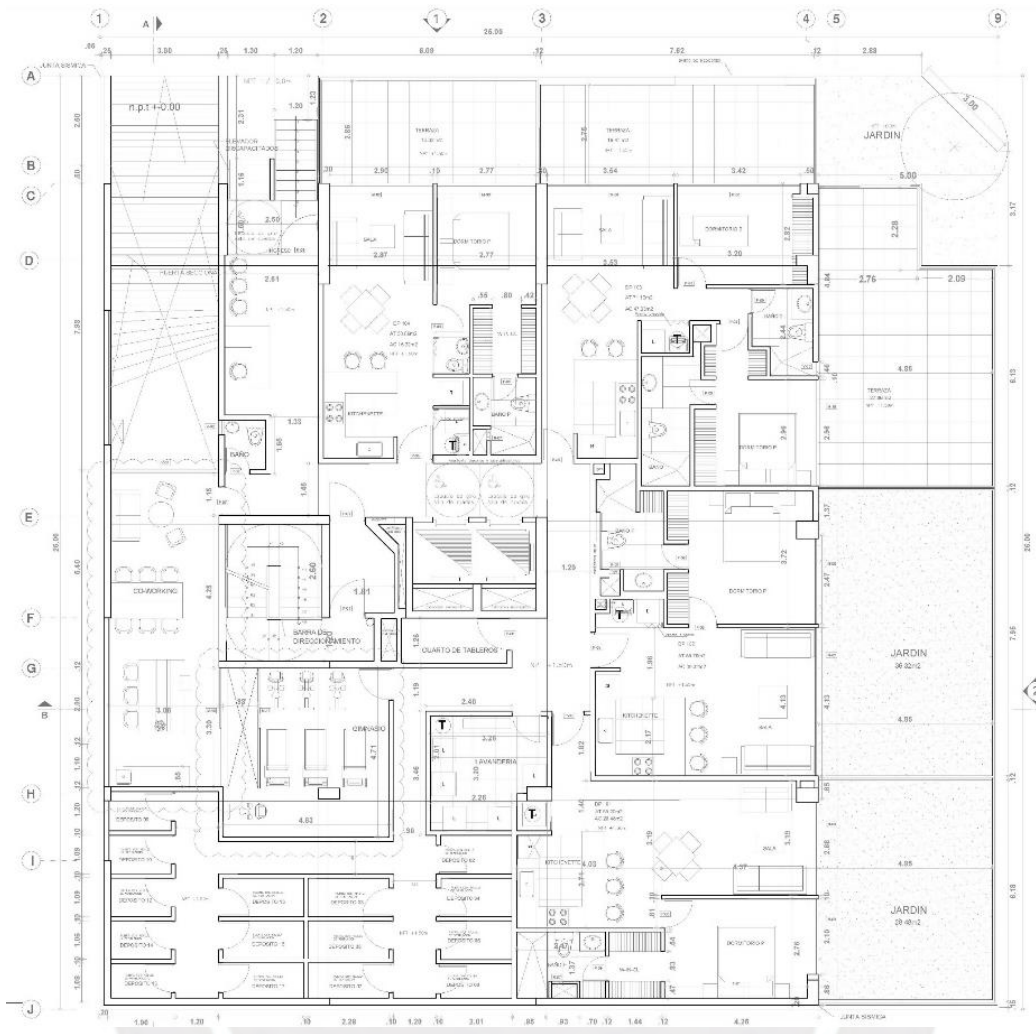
Planta baja proyecto QIU. Fuente: Plano editado de EE inmobiliaria
